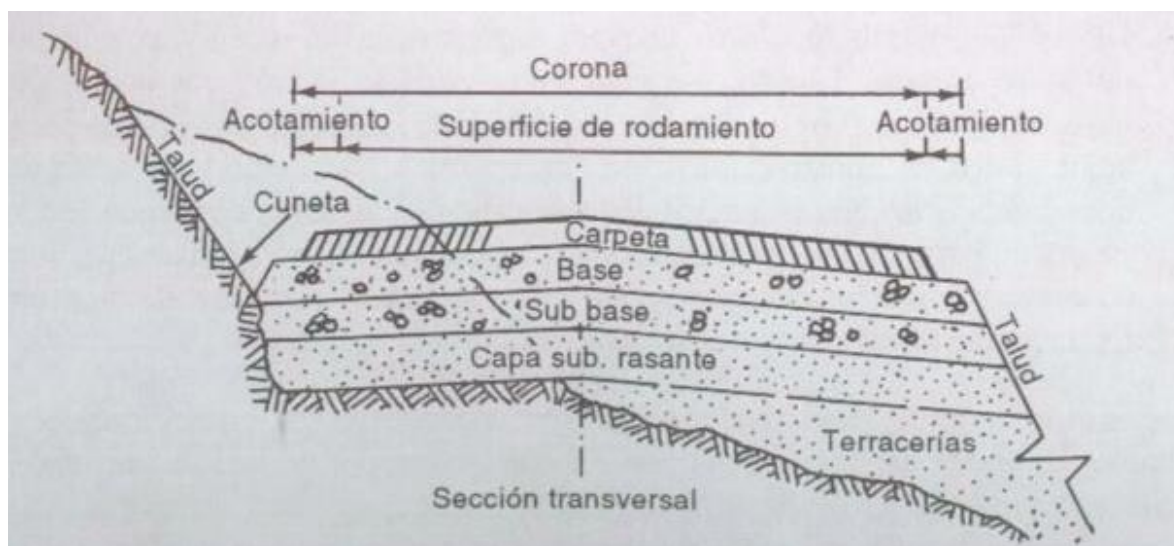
Sección transversal de la estructura de pavimentos flexibles.
